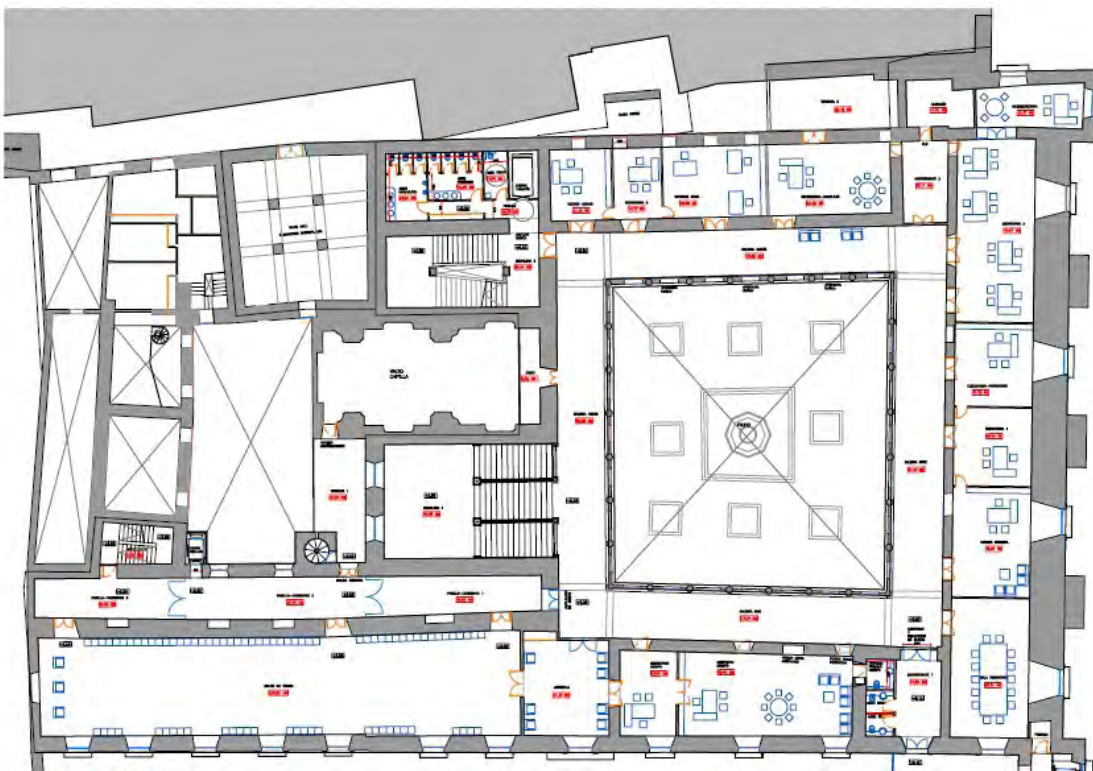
Estado reformado. Planta primera (OAFJ, fragmento del plano R03).
